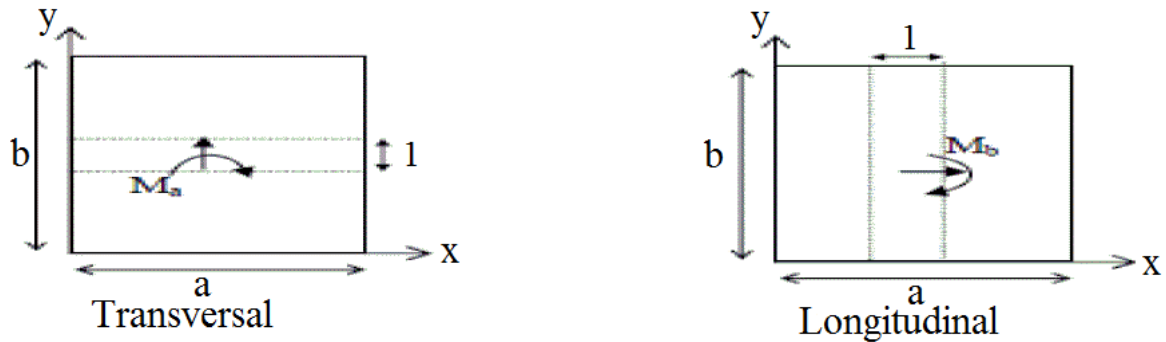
Moment transversale et longitudinale sur la dalle centrale.
